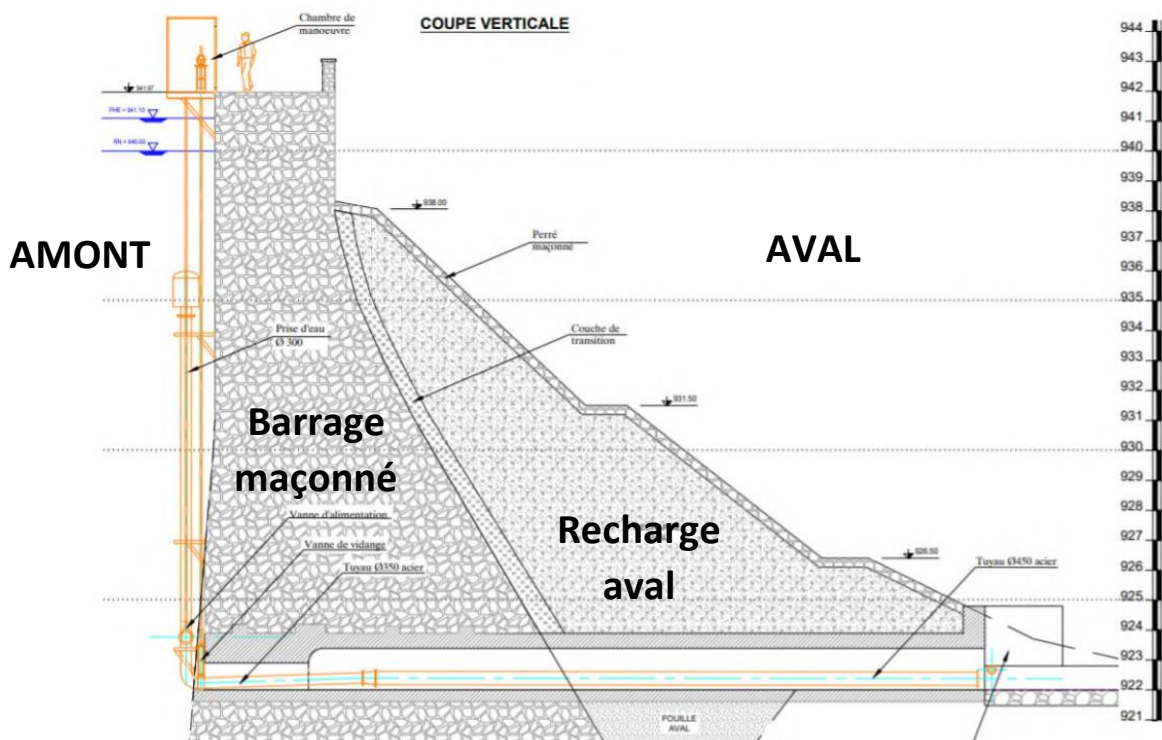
Coupe du barrage actuel au droit de la vidange de fond
